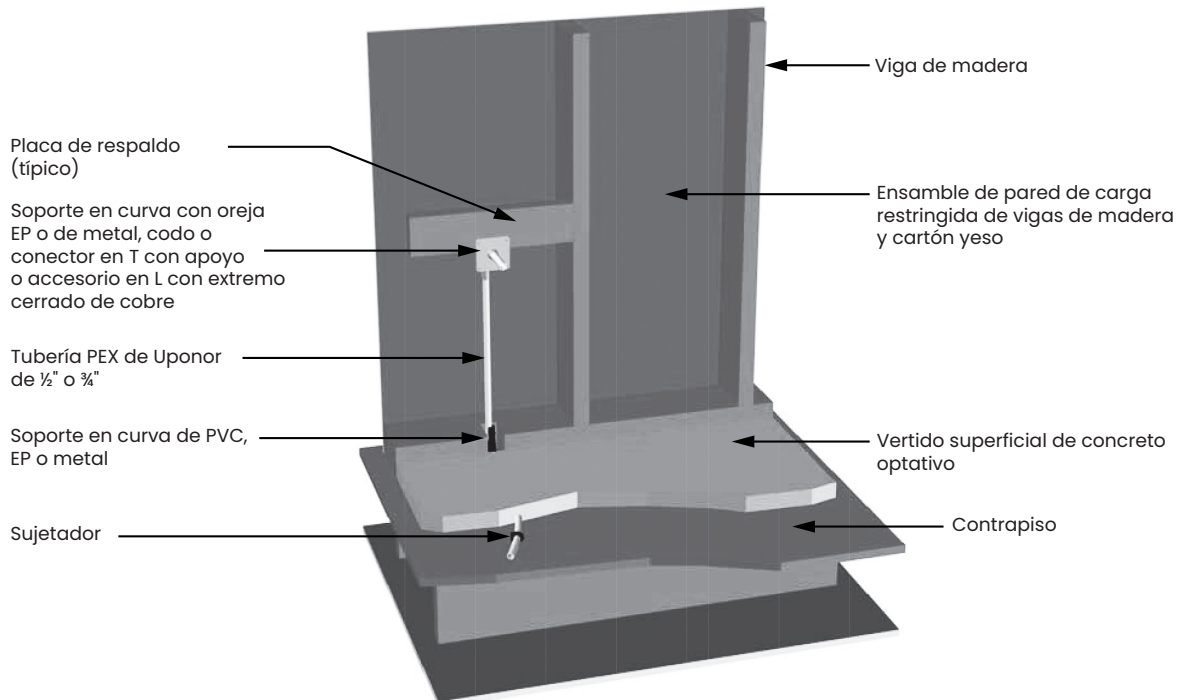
Detalle de dispositivo 2 (Canadá)
